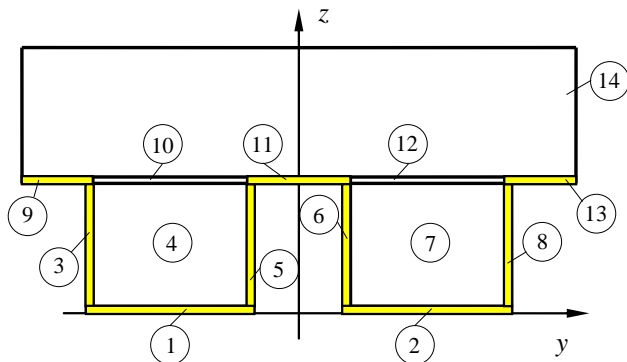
Апроксимований переріз легкобетонної плити з профільованим настилом
